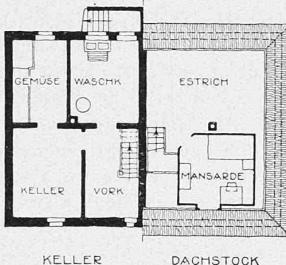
Grundrisse der ausgeführten Häuser. — Massstab 1 : 300. — Abb. 4. Grundrisse laut erstem Vorschlag.
